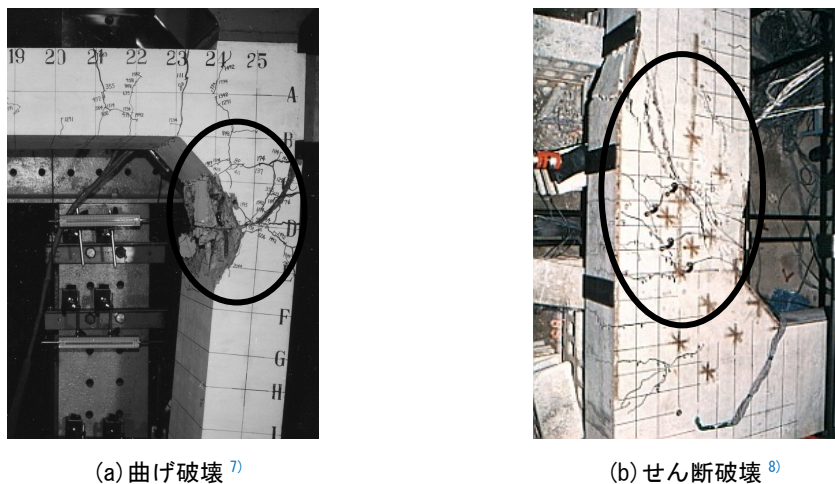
鉄筋コンクリート製ラーメン構造の破壊の例
